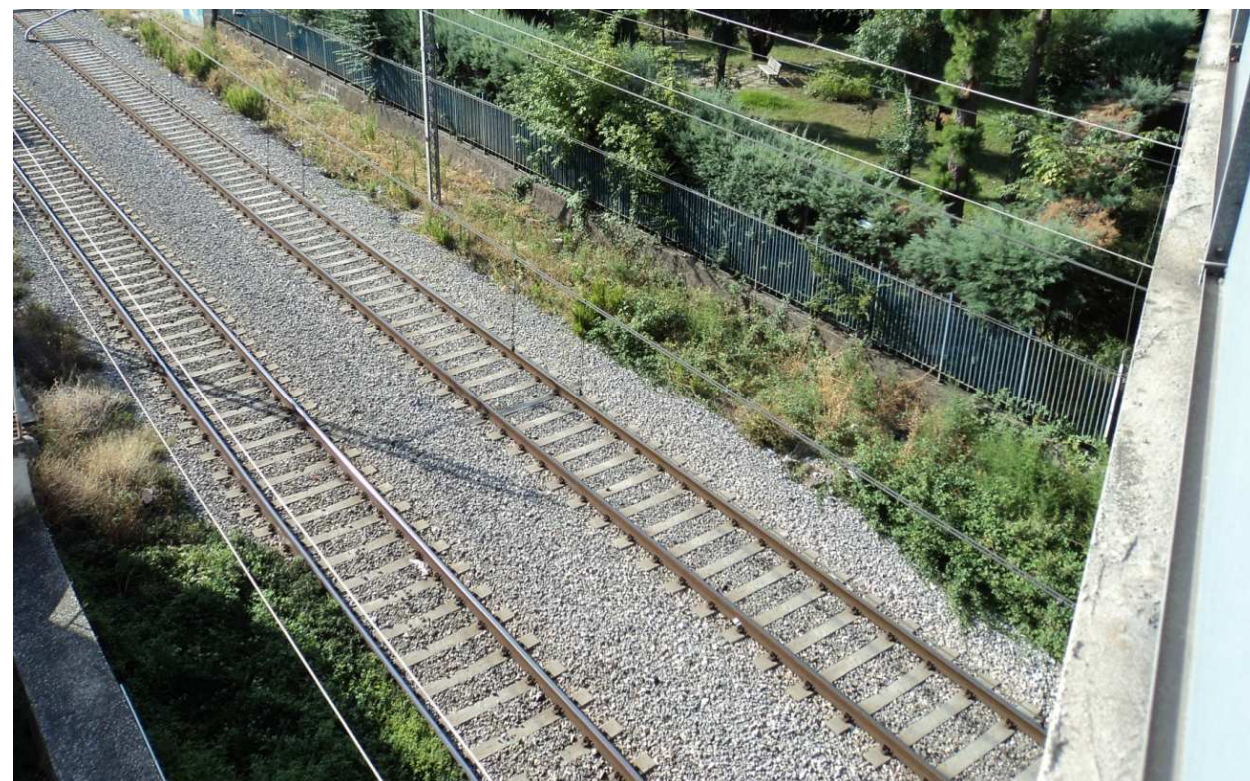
Cavalcaferrovia a via Libertà, al Km 221+220 della linea storica: vista dall'impalcato lato Canello
